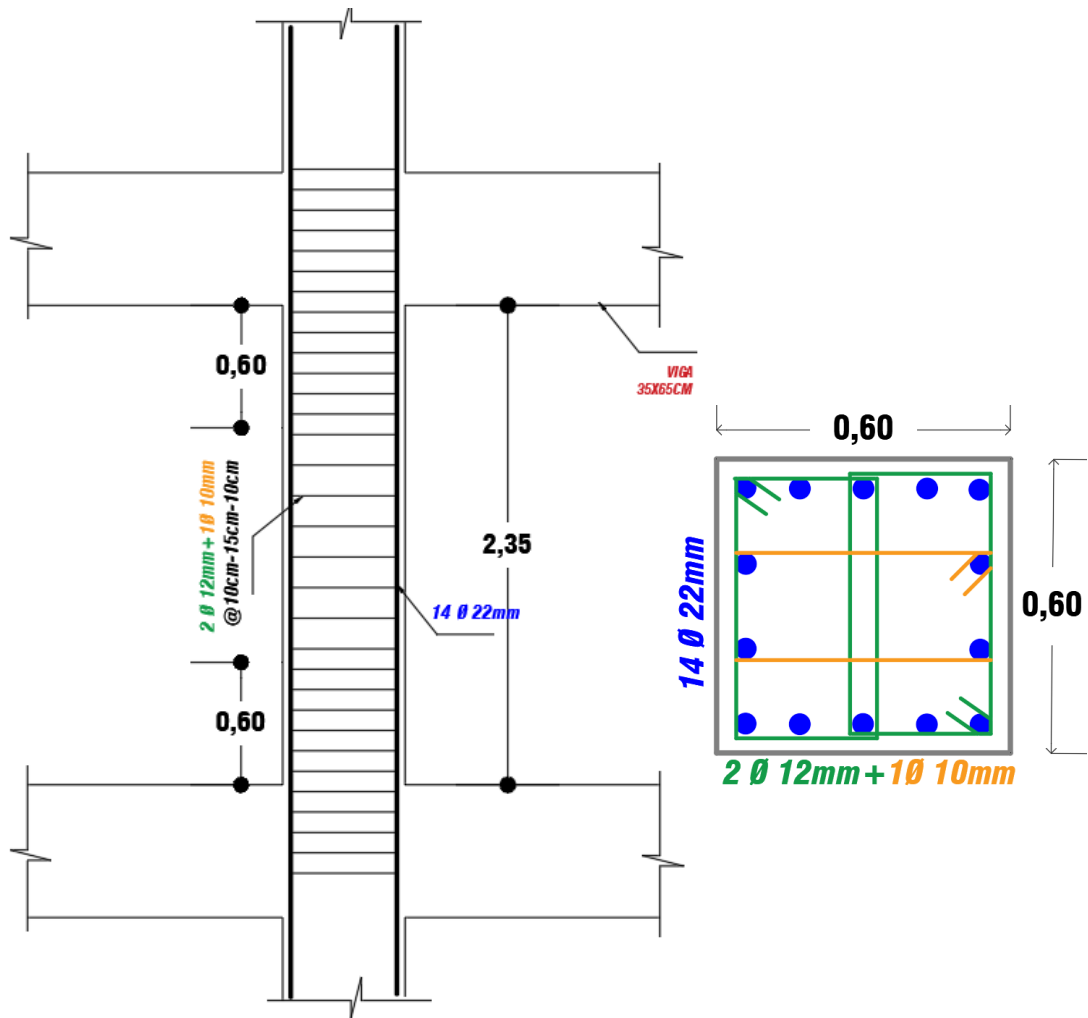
Detalle de Acero transversal y longitudinal de la columna del sistema R=5
